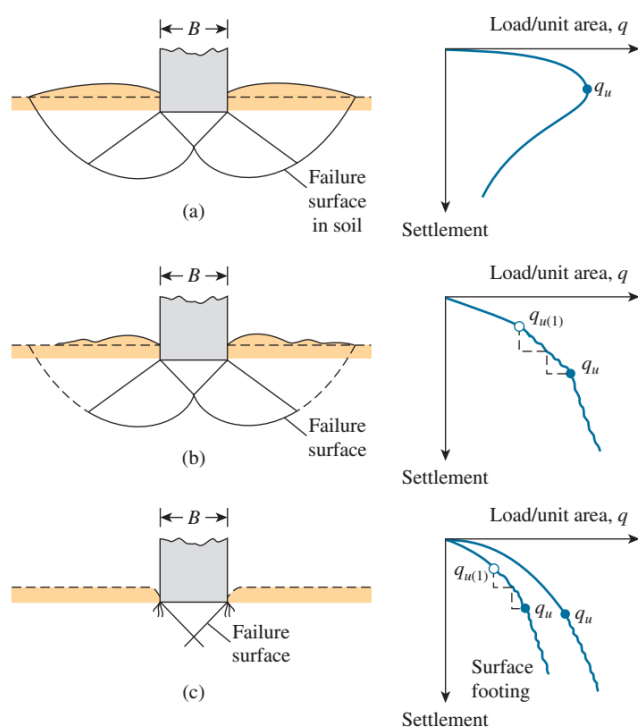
Mécanisme de rupture sous une fondation superficielle [9]
